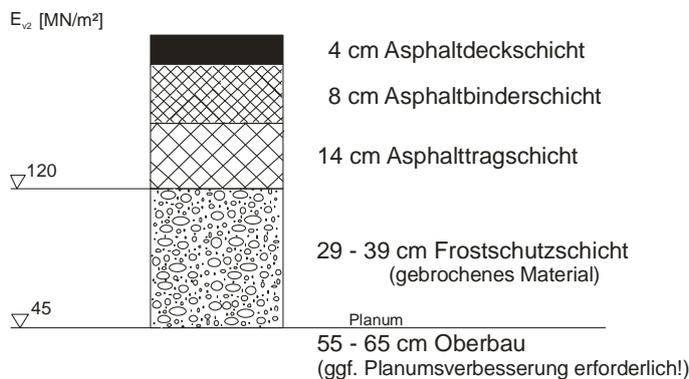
Beispiel einer Bauweise mit Asphaltdecke für Bauklasse II gemäß RStO 01
